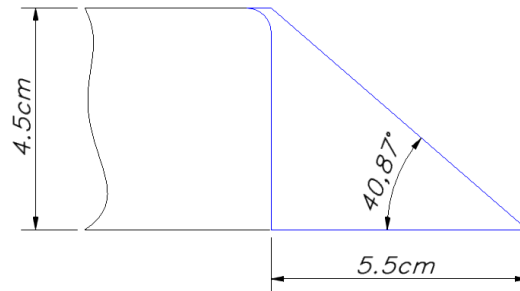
Rampa para subir a la losa. Fuente: Elaboración propia
